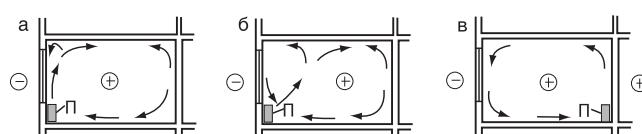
Схемы циркуляции воздуха (показаны стрелками) при размещении отопительных приборов: а – под окнами без подоконников; б – с подоконниками; в – у внутренней стены
